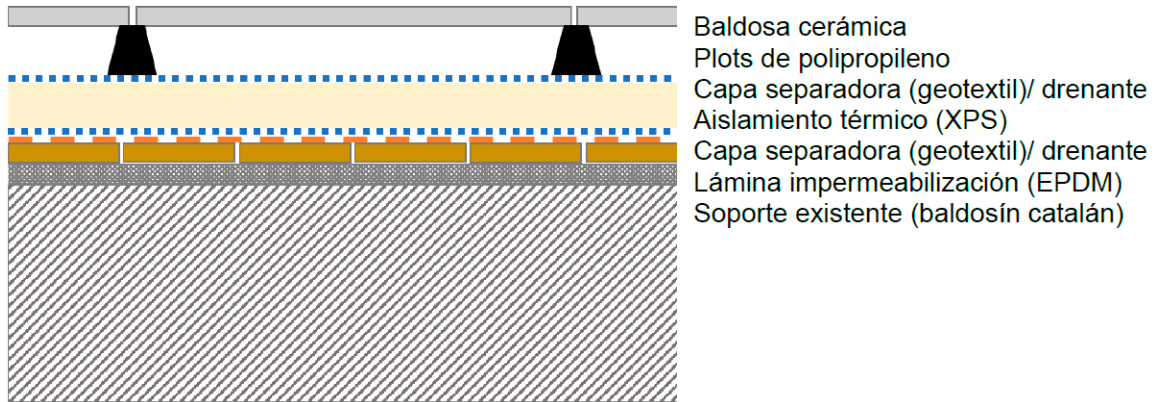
Esquema/ Componentes de la Cubierta invertida con pavimento sobre elevado.
